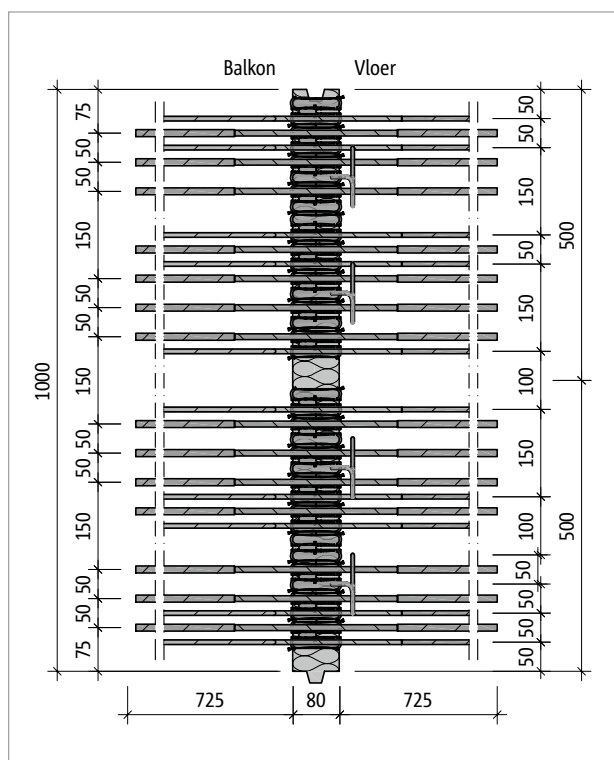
Schöck Isokorf® T type K-E-M6, K-T-M7, -M9, -M10: Zijaanzicht
